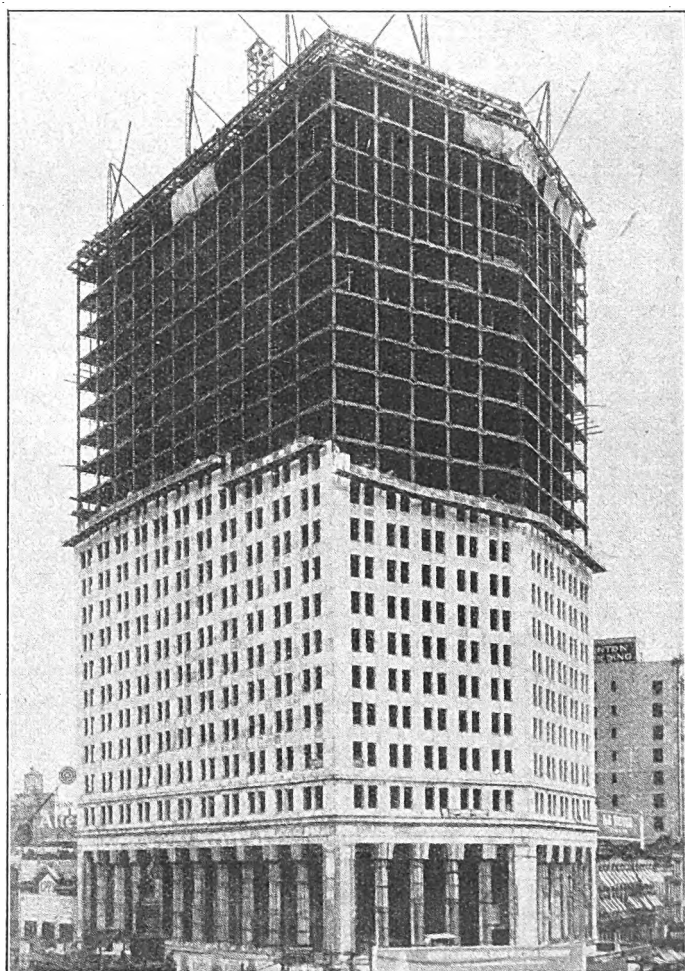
Ausföhrung eines Stahlgerippe-Hochhauses in Detroit (Michigan, Nordamerika) von der Schnellbaurüstung
